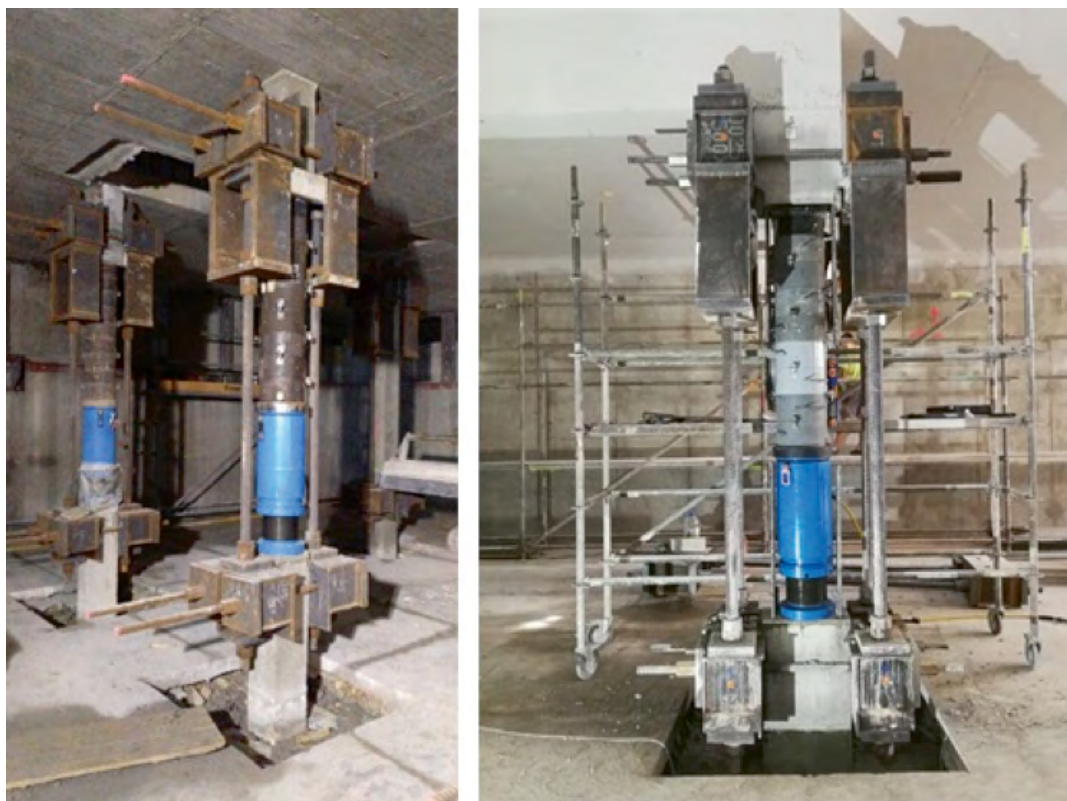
Estructura metálica auxiliar con gatos colocados en soportes tipo de cimentación.
